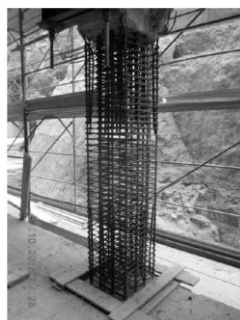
Vista pilastro 53 durante la ricostruzione Fig. 16. Vista pilastro 53 dopo la ricostruzione
